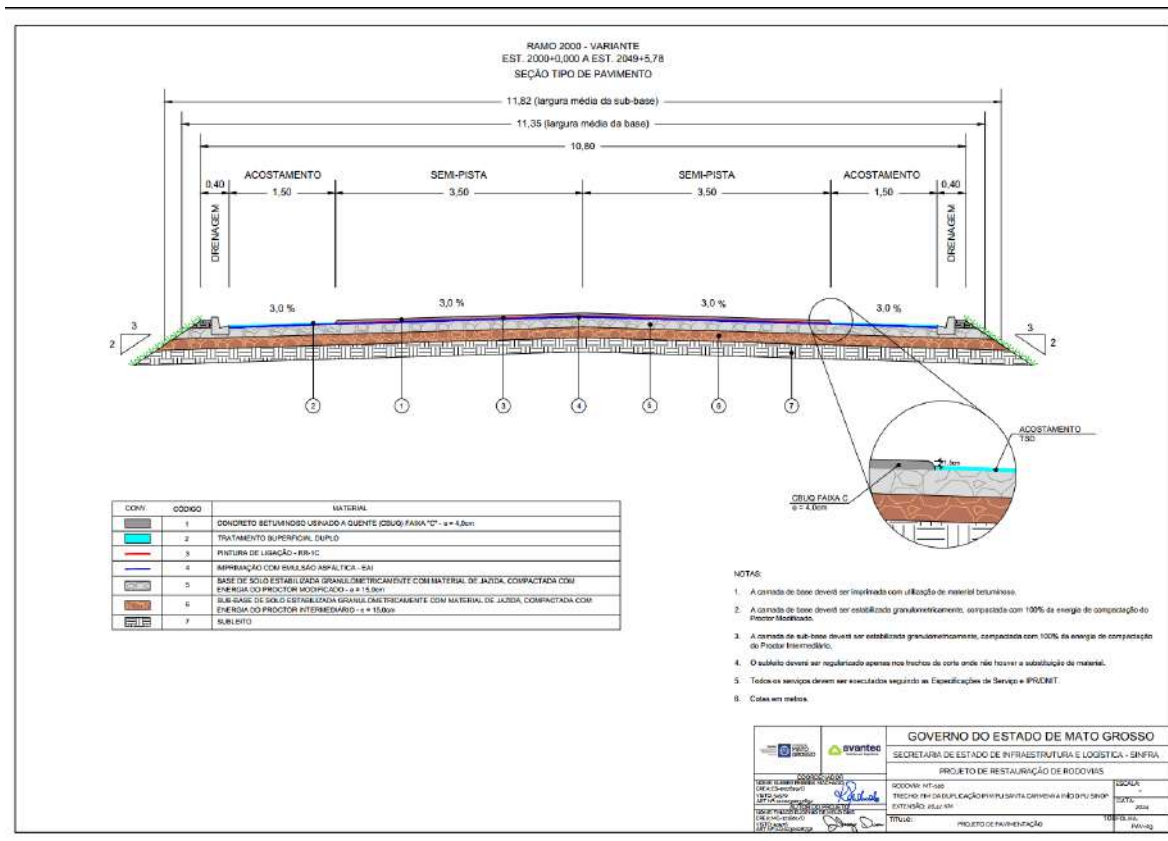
Seção Tipo do Pavimento – Ramo Variante
